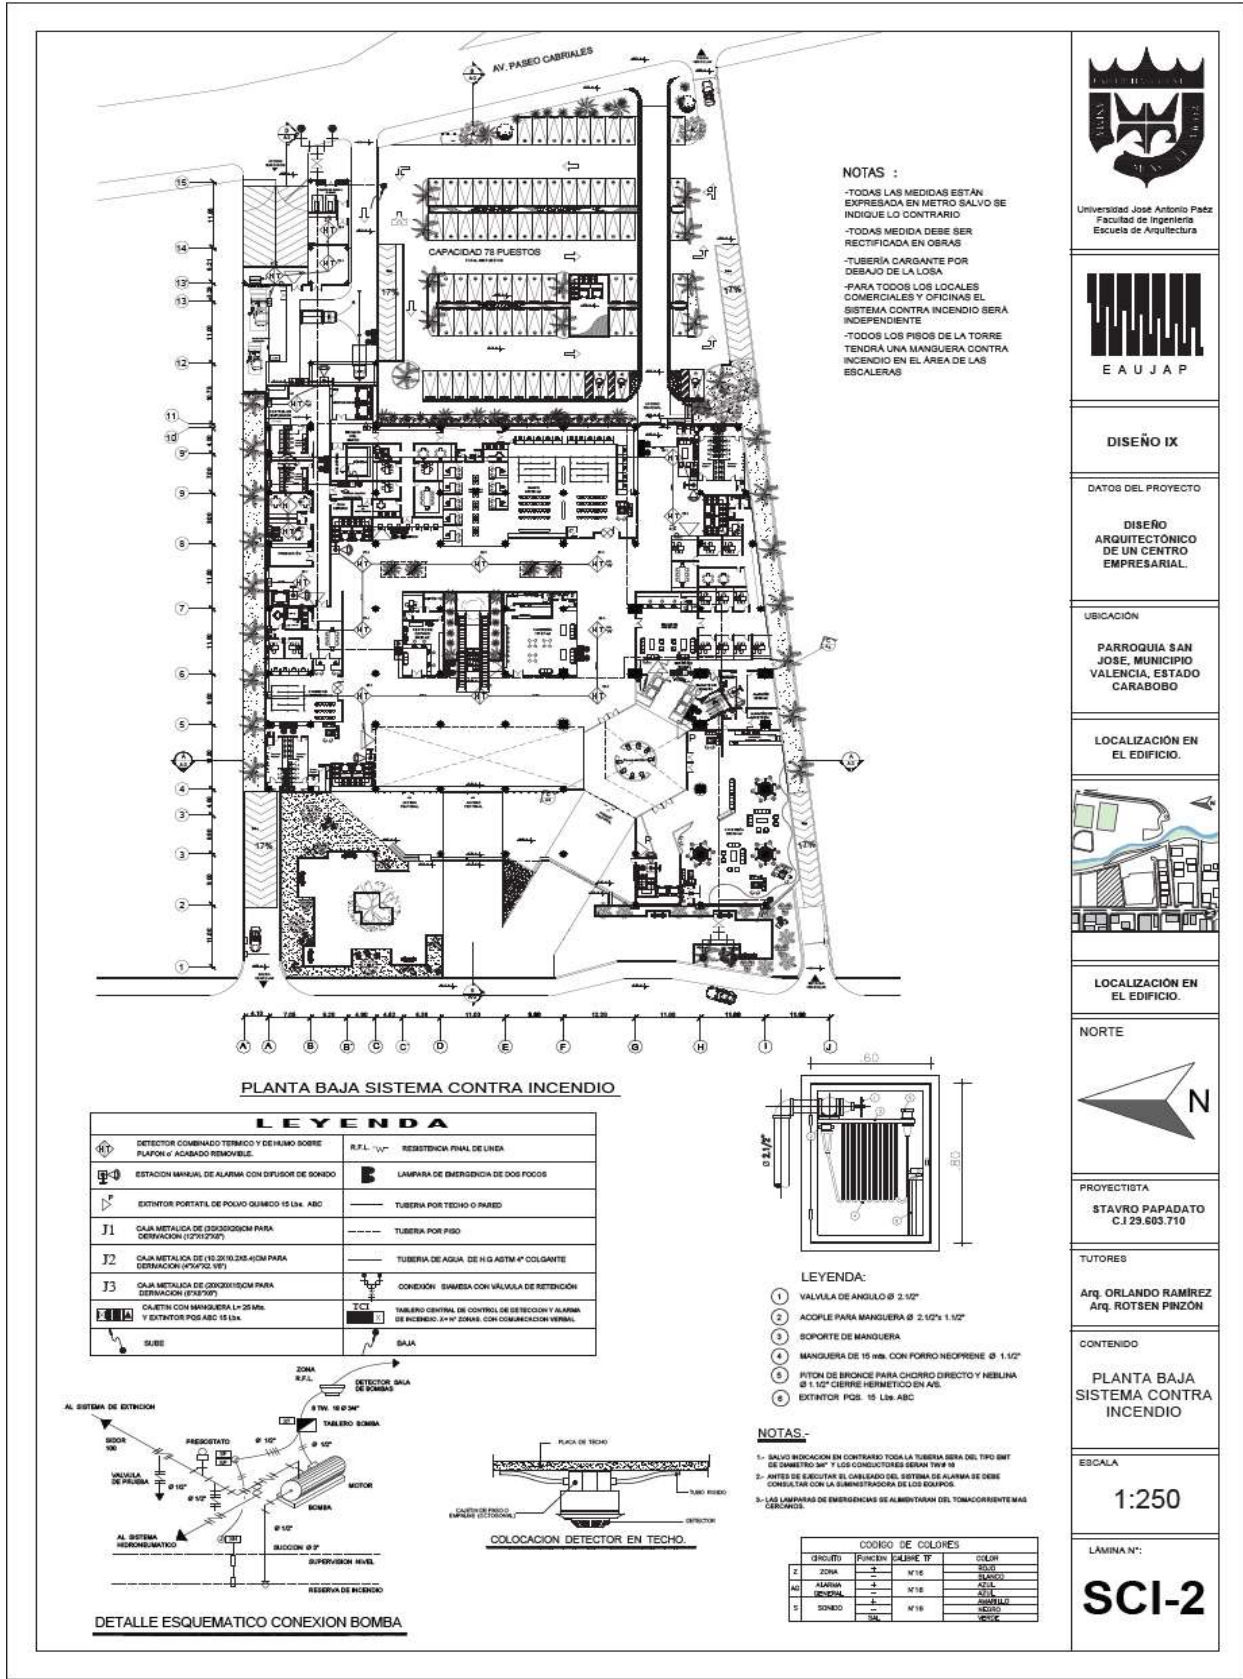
SCI-2. Planta Baja Sistema Contra Incendio Fuente: El Autor (2023)
